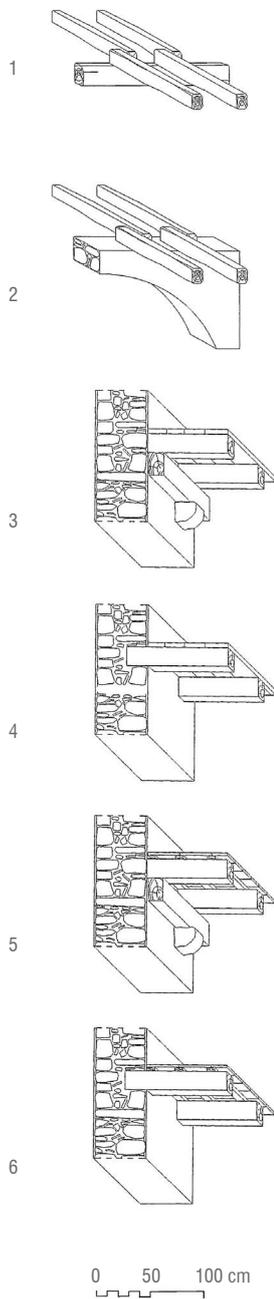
Estrutura das coberturas e pavimentos entre pisos:
